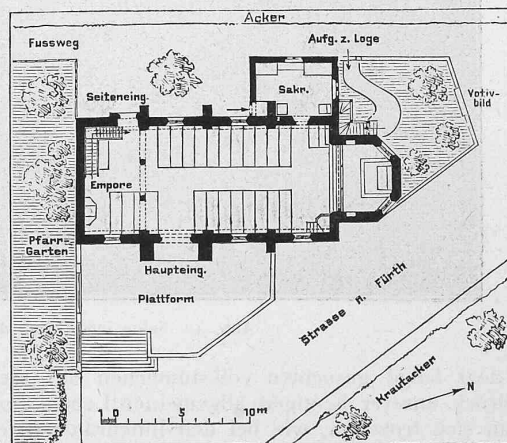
Grundriss der Kirche von Zirndorf. — 1 : 500.
